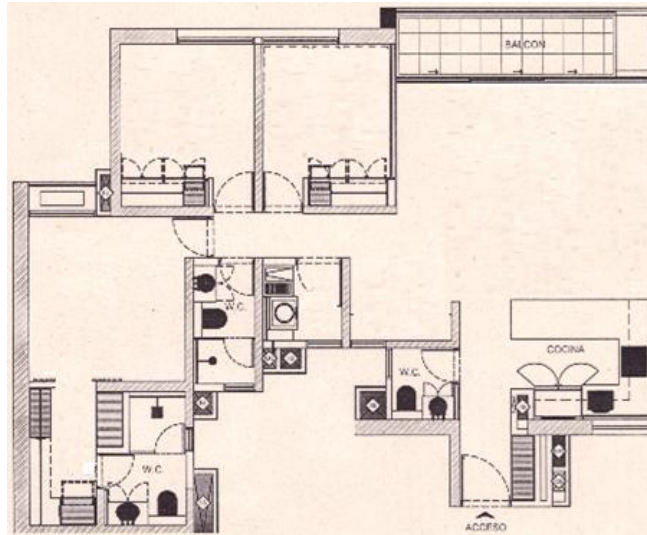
Plano de apartamento típico. Fuente: Elaboración propia.
